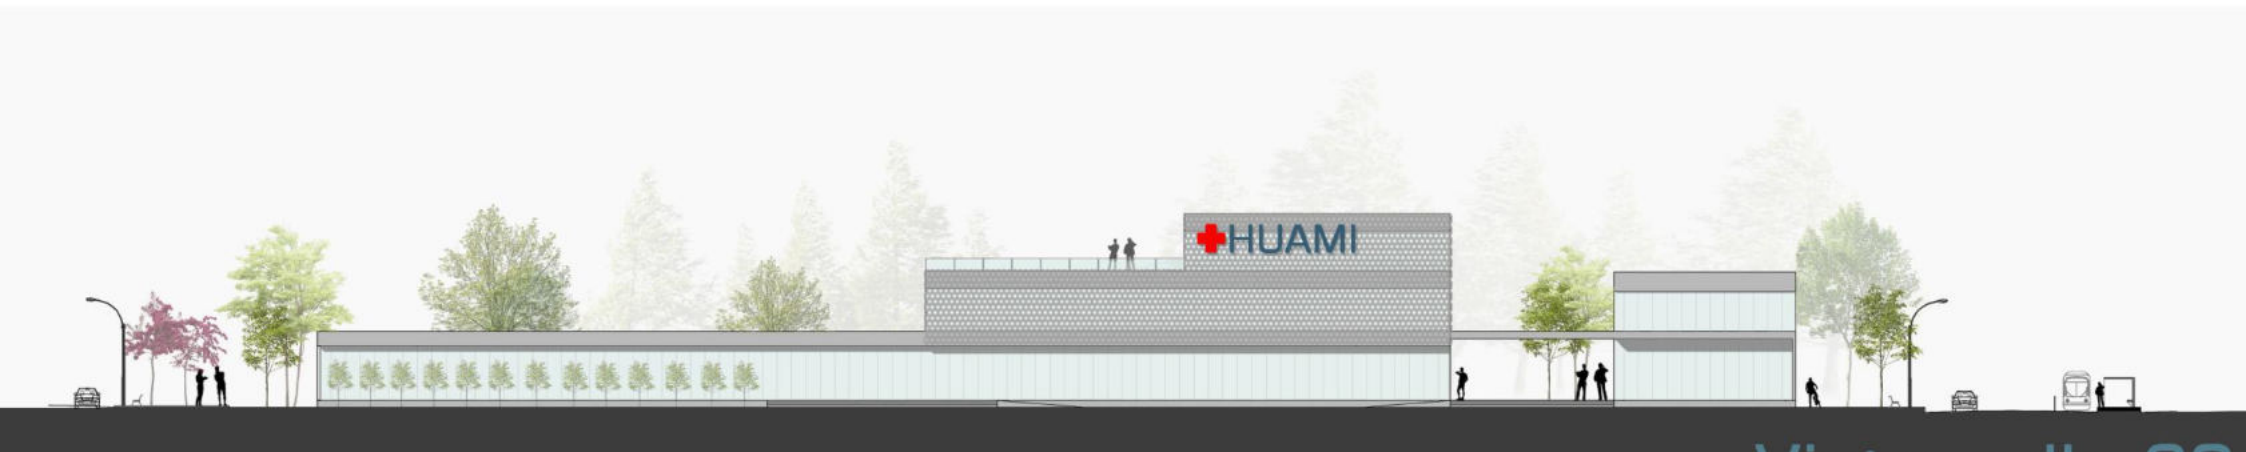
IMAGEN Vista aérea Fachada Principal sobre Calle 39
